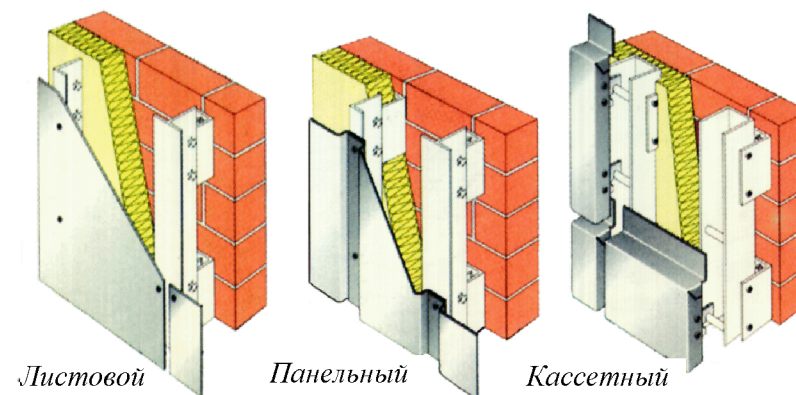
Основные варианты монтажа металлических фасадных облицовок.
